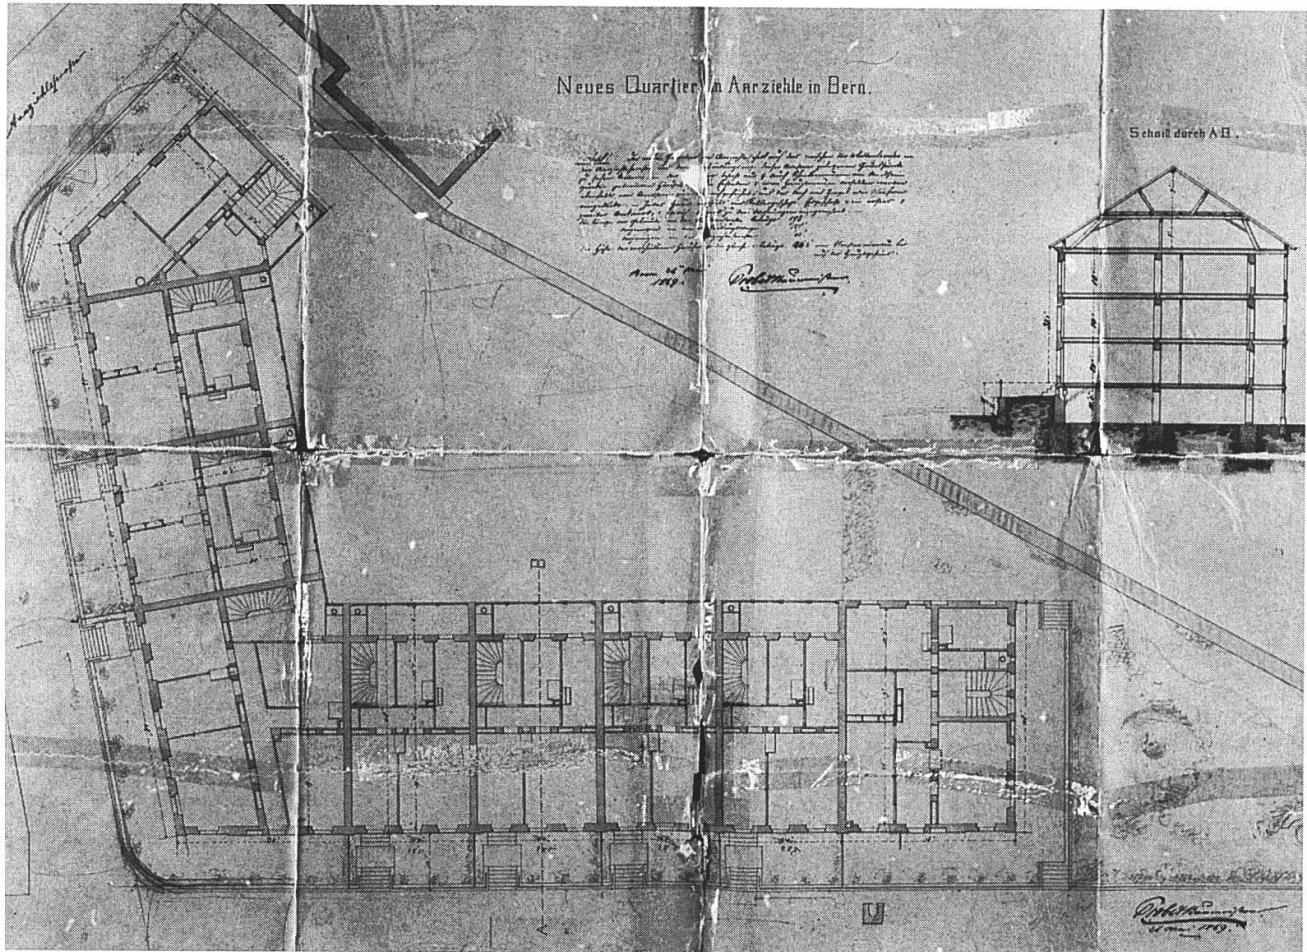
Aarstrasse 102–108 / Ländteweg 1–5 im Marzili. Situationsplan mit Geschossunterteilung von 1869.
